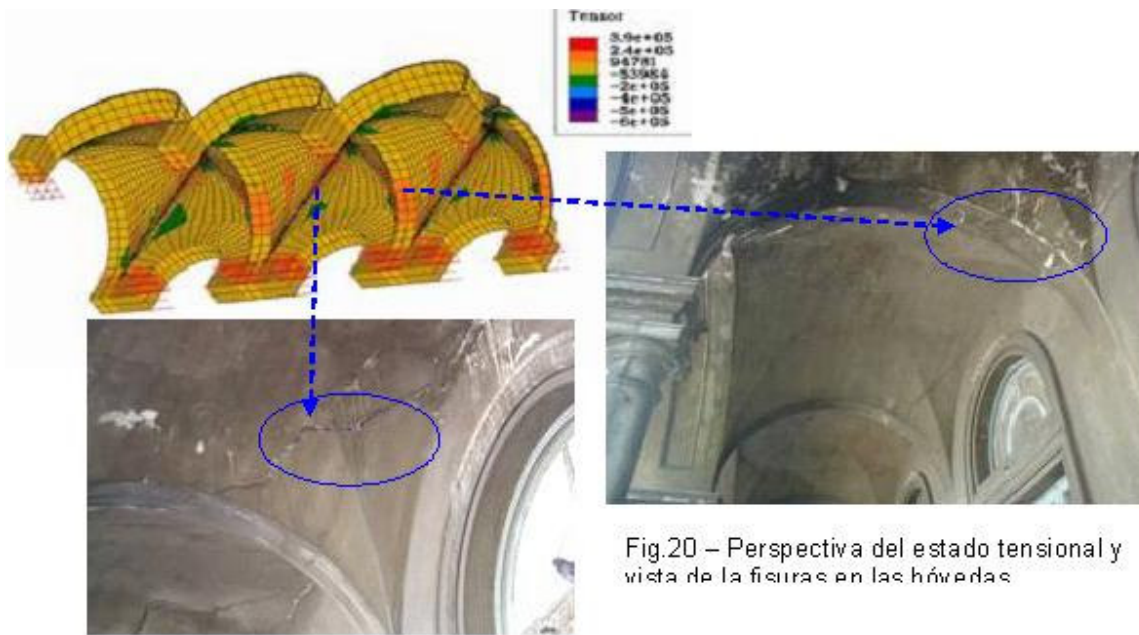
Perspectiva del estado tensional y vista de la fisuras en las bóvedas
